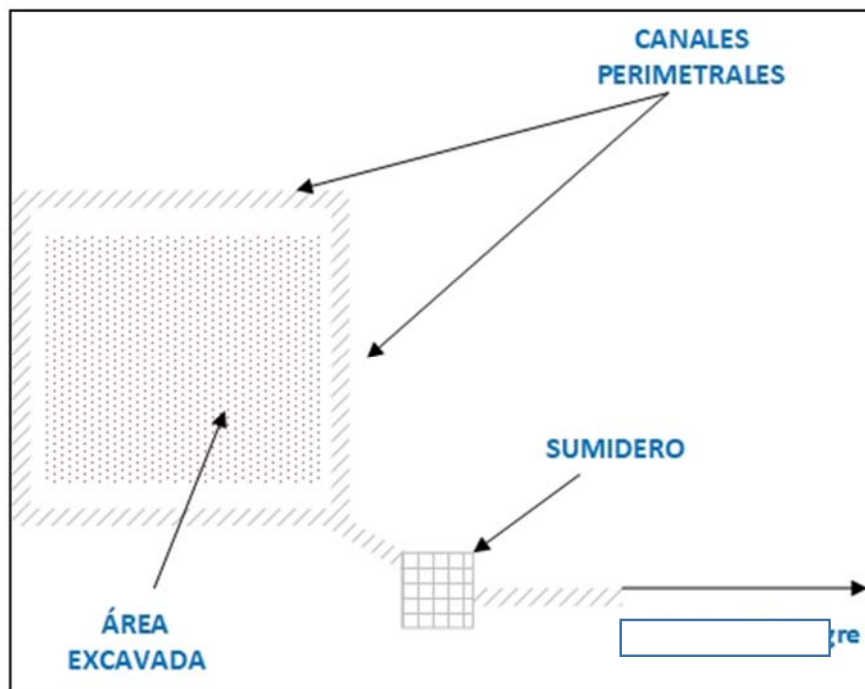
Esquema del Sistema de Drenaje Pluvial – Vista de Planta
